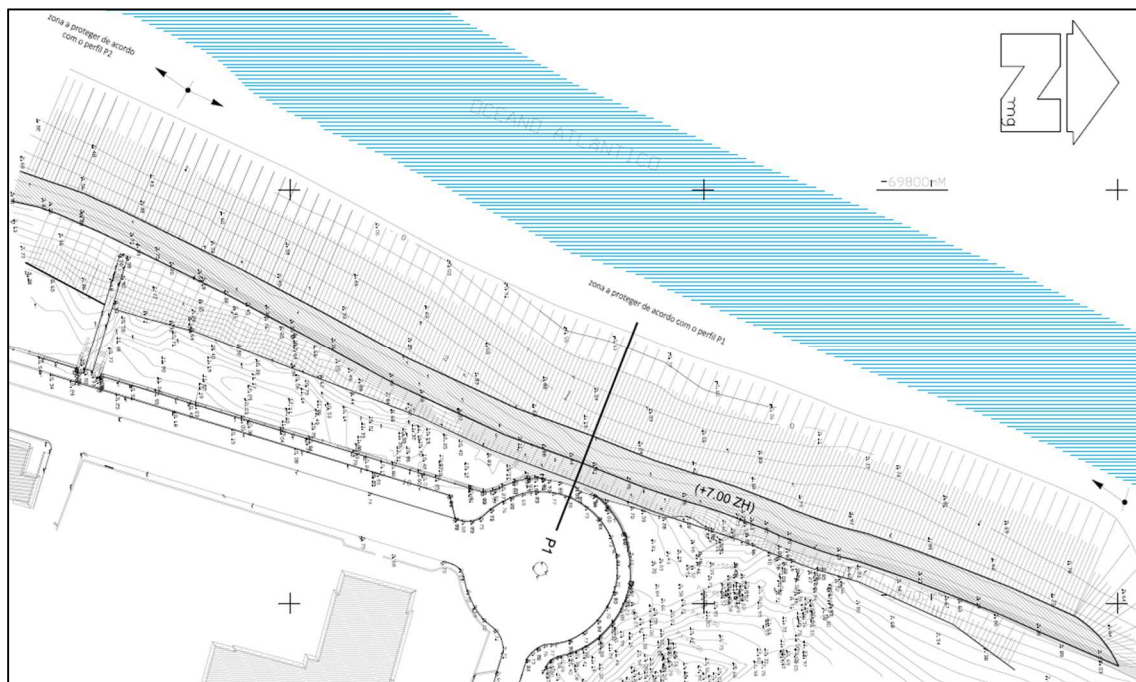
Troço do Casal Ventoso – Planta (fonte: APA, fevereiro de 2014)
